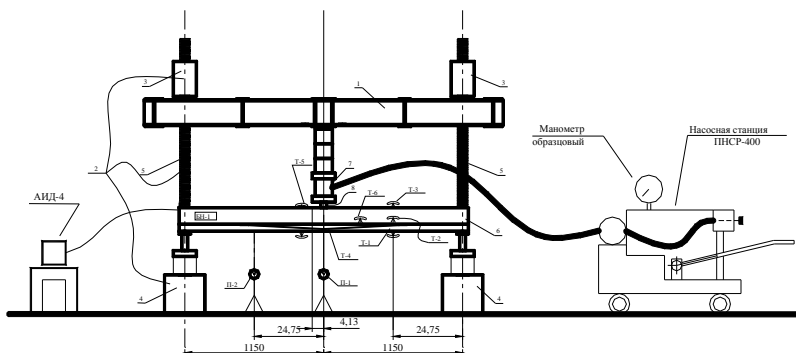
Принципиальная схема стенда, расстановки приборов и нагружения локально предварительно напряженной сталежелезобетонной балки с железобетонной полкой в растянутой зоне
